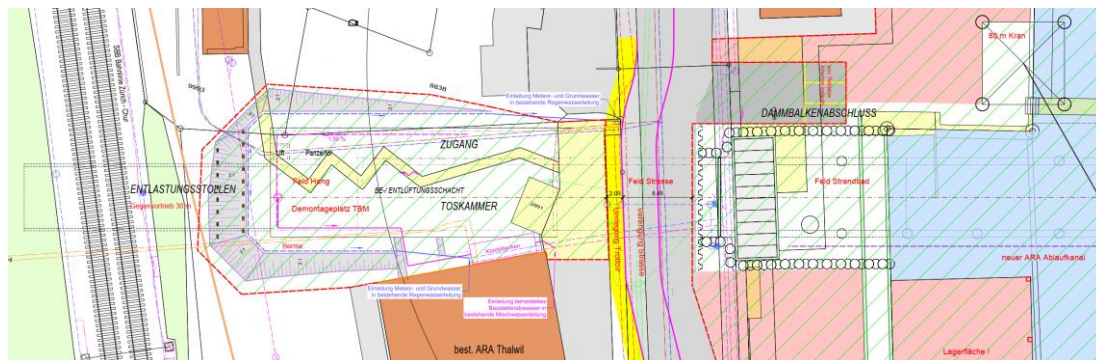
Bauphase 2: Arbeiten im Feld Hang (Auszug aus Plan 33-309)
